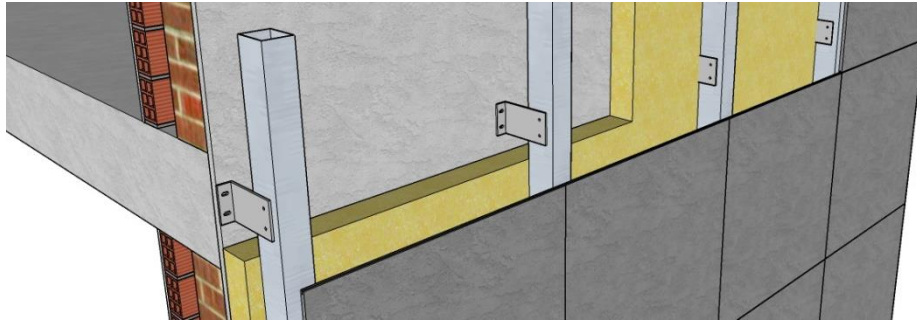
La subestructura de la fachada ventilada se fija a los frentes de forjado mediante anclajes de aluminio.
